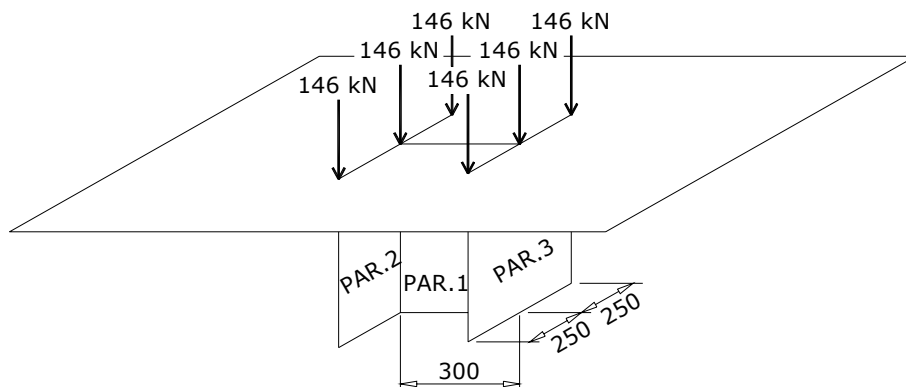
Disposição das alvenarias sobre as vigas de fachada do 1º ao 29º andar (cotas em centímetros)
